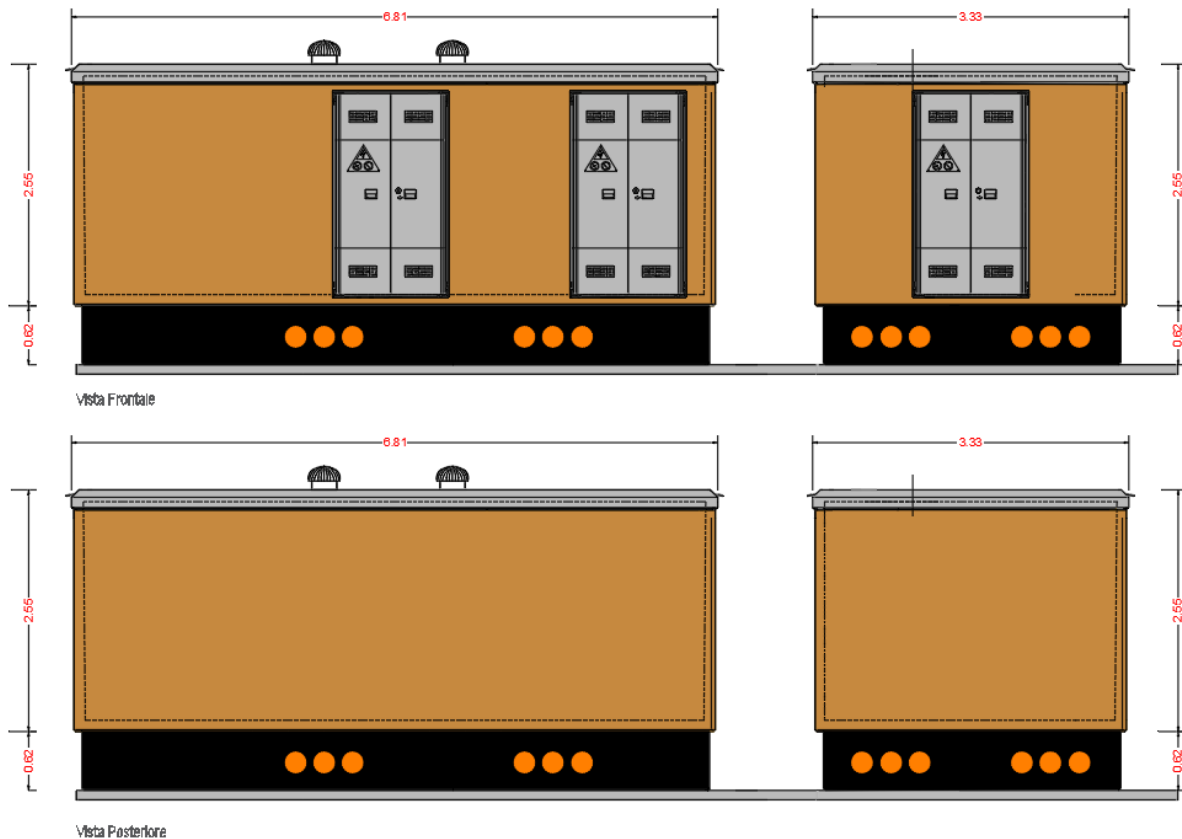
Planimetria cabina di Raccolta MT – prospetti frontale e del retro
